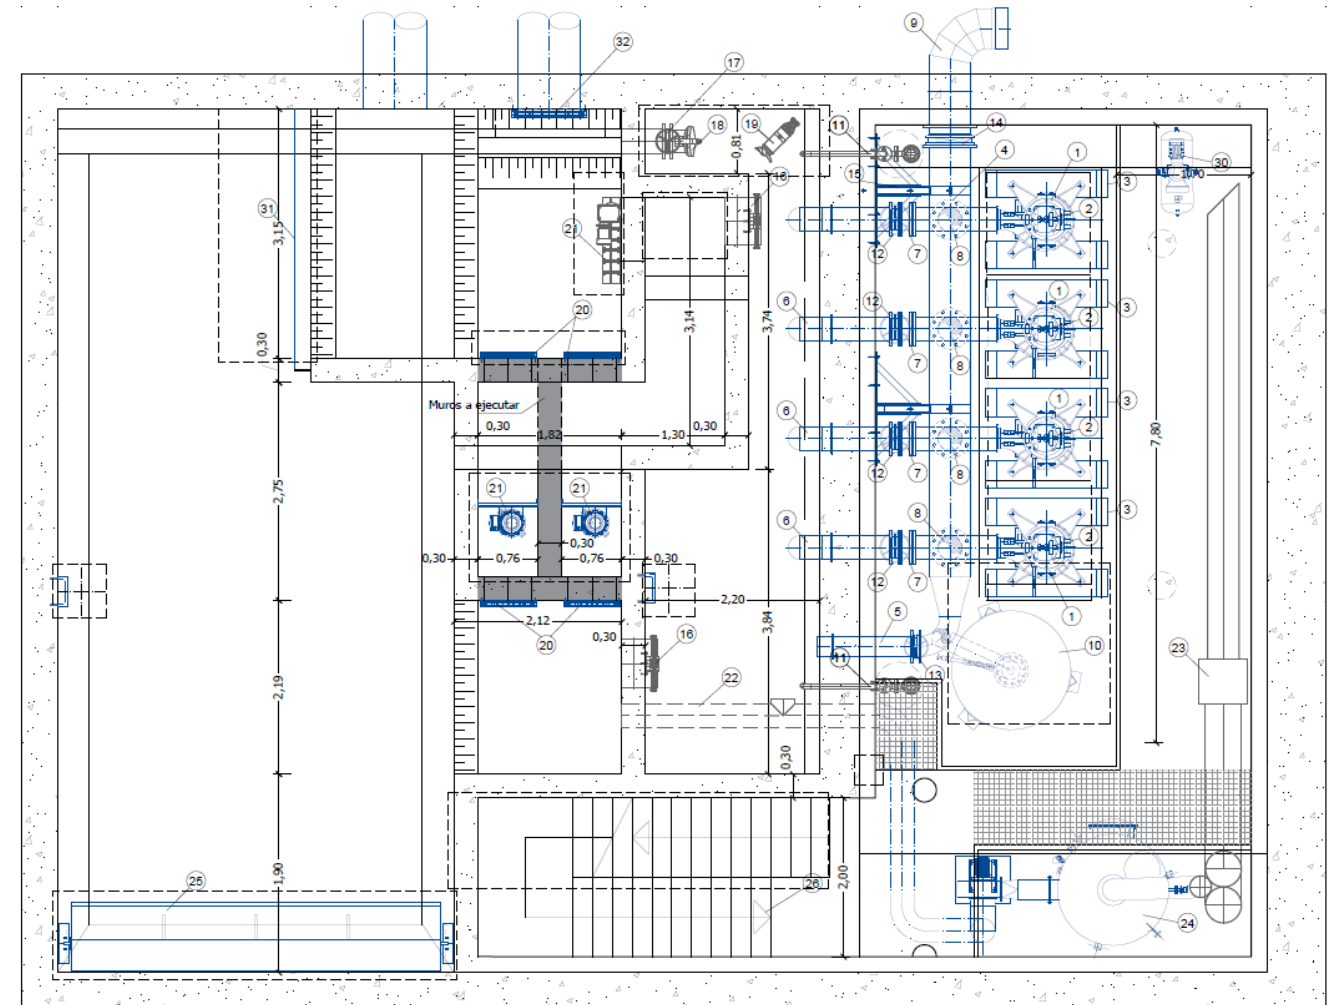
Planta del bombeo de Espiñeiro tras los trabajos proyectados
